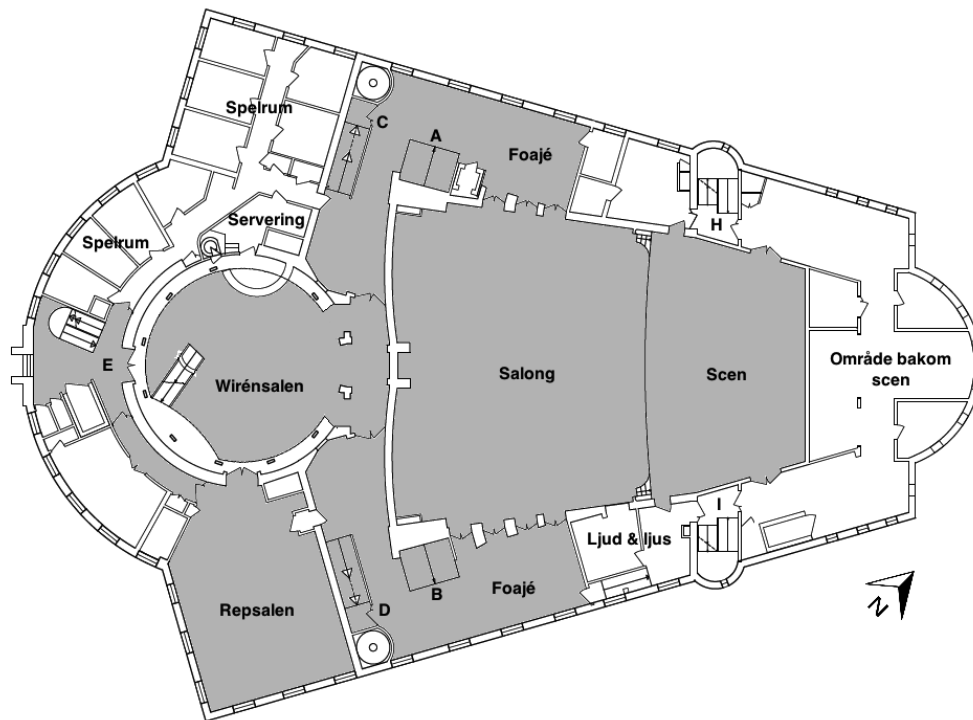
Planritning över plan 1 med trapphus och utgångar utmärkta. Publika delar är gråmarkerade.
